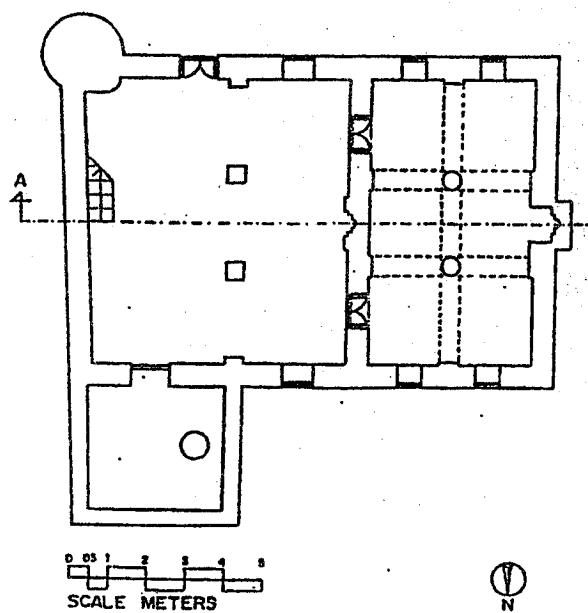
مسقط أفقى لمسجد الفوروداني بزنجبار.
